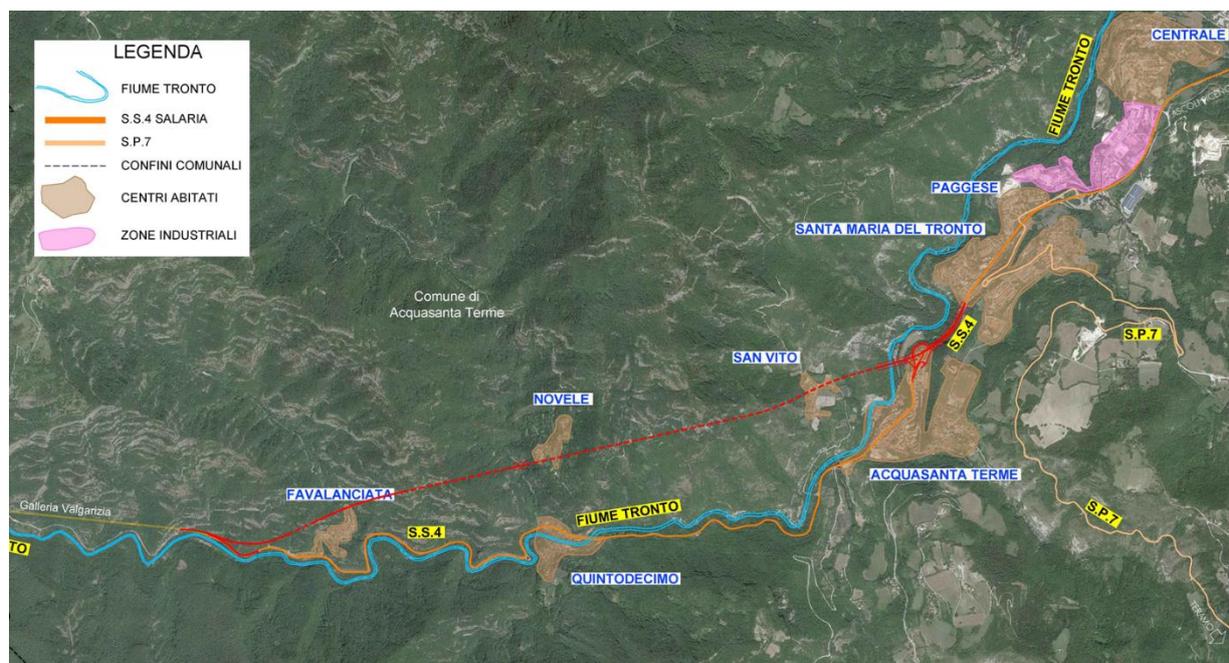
Alternativa 1 - Planimetria su fotomosaico
